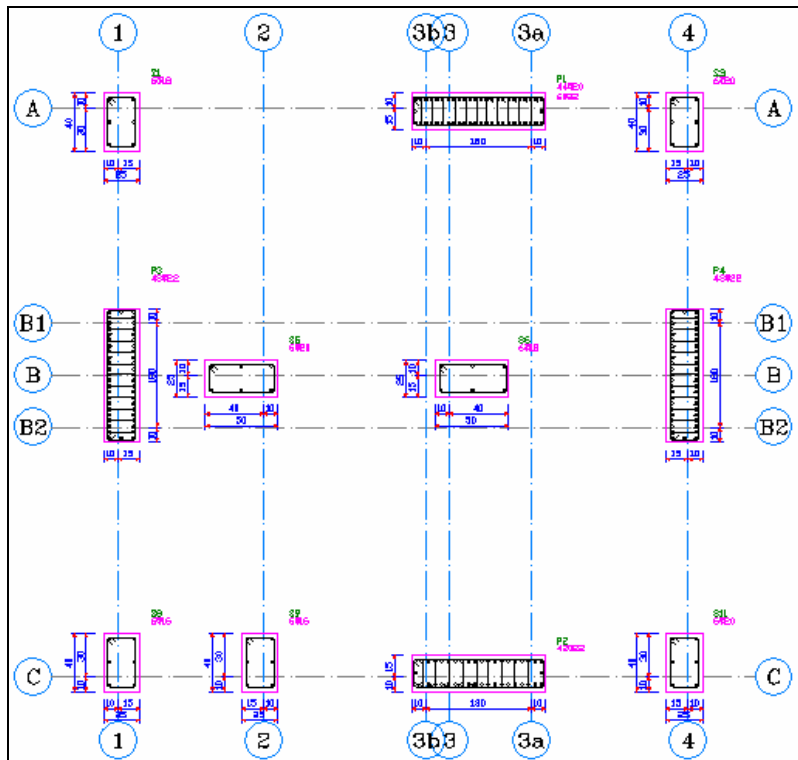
Kirişli döşemeye sahip 5 katlı betonarme perdeli - çerçevesi yapının kolon aplikasyonu
